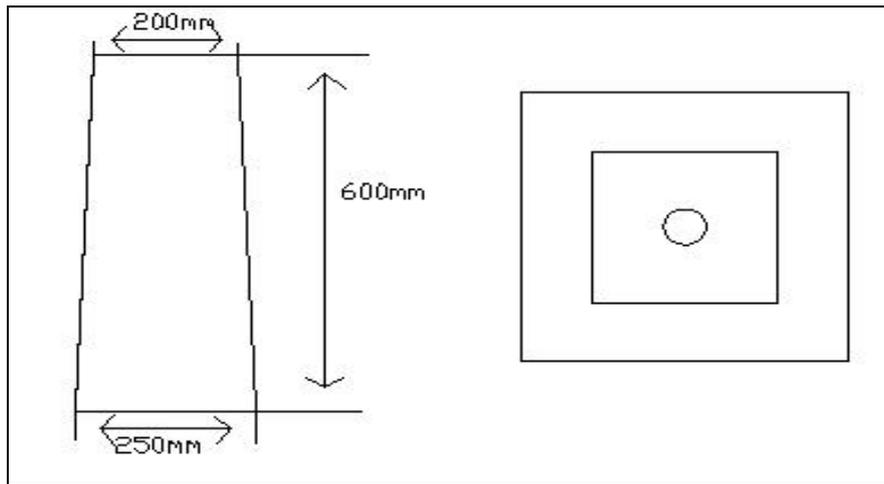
采空塌陷观测桩结构及埋设示意图(单位: mm)
